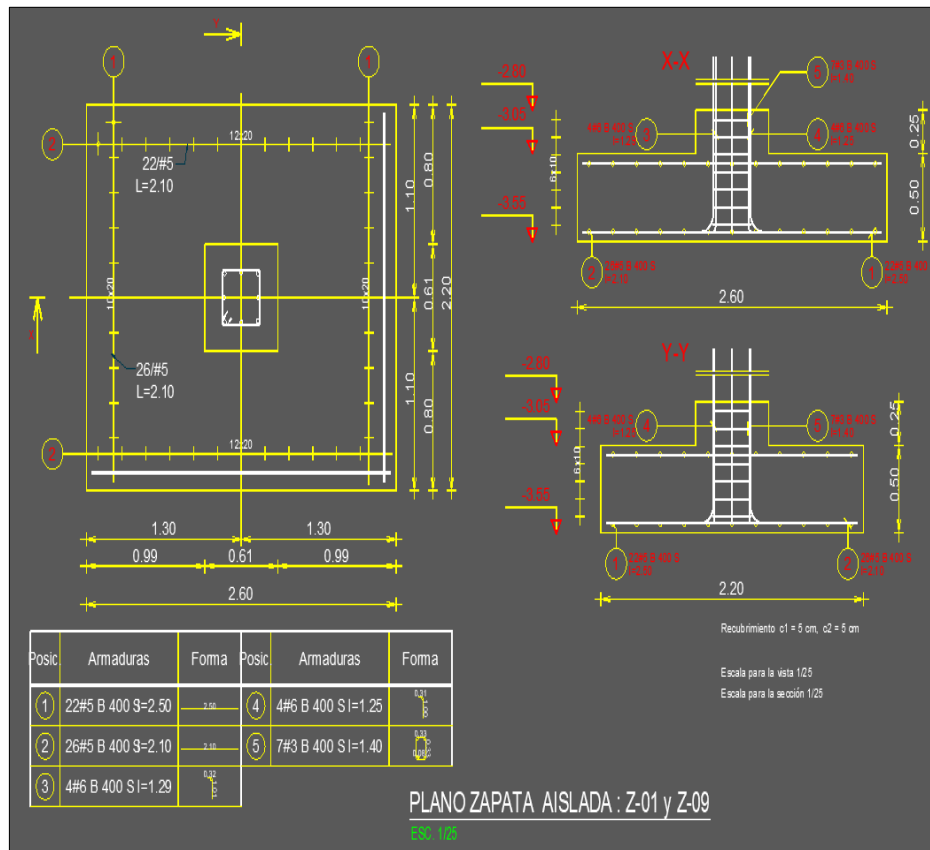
Plano en planta y cortes de la zapata C01-01. Aislada céntrica
